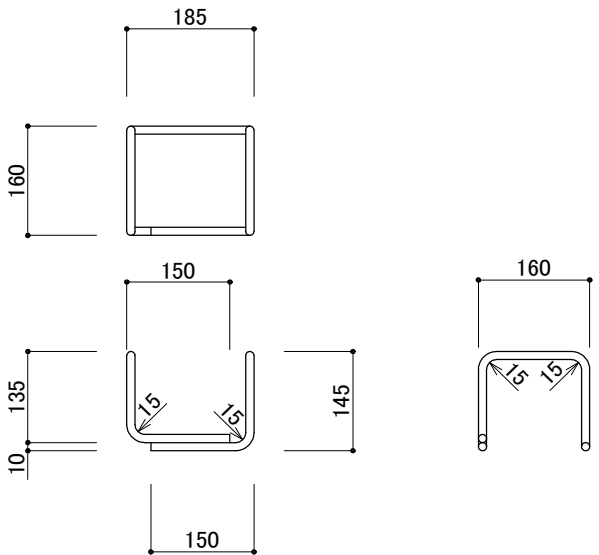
シリーズ1 基礎梁実験の試験体の配筋
